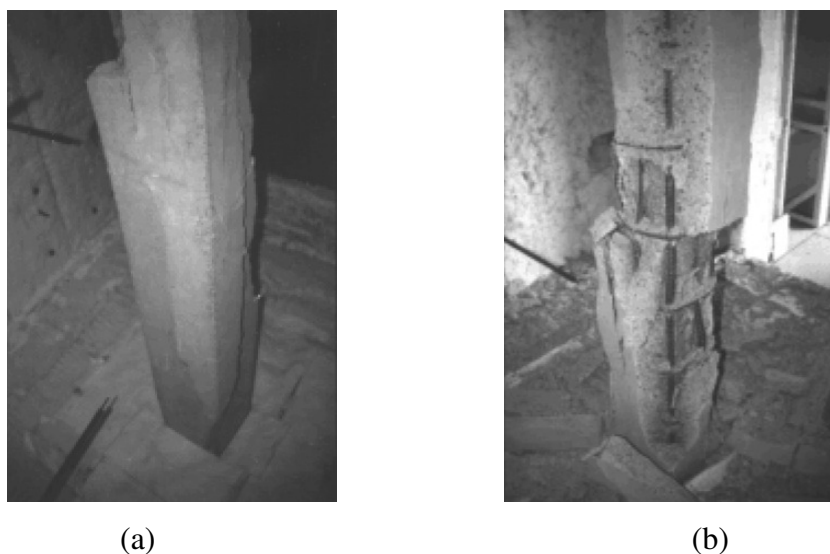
Spalling* após a exposição ao incêndio de um pilar com concreto normal (a) e um pilar com concreto de alta resistência (b) (Kodur e Harmathy, 2002).
